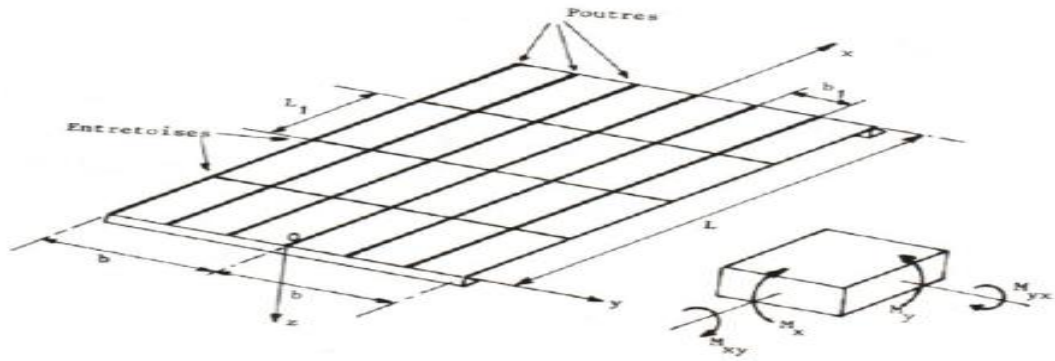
Assimilation du réseau de poutres à une dalle orthotrope
